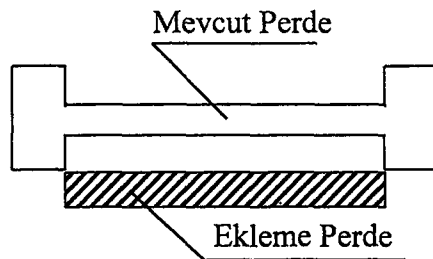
Perde Duvarı BETONLAMA YÖNTEMLERİ
